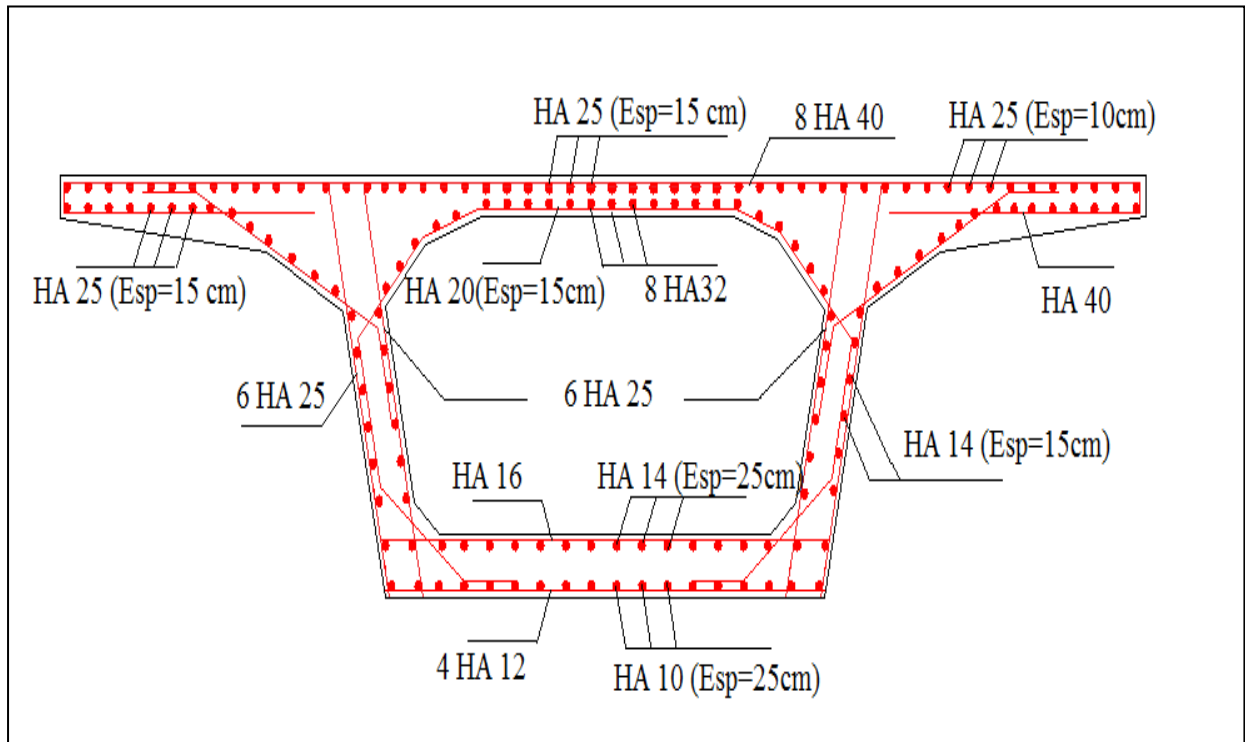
Schéma du Ferrailage du voussoir près de la pile
